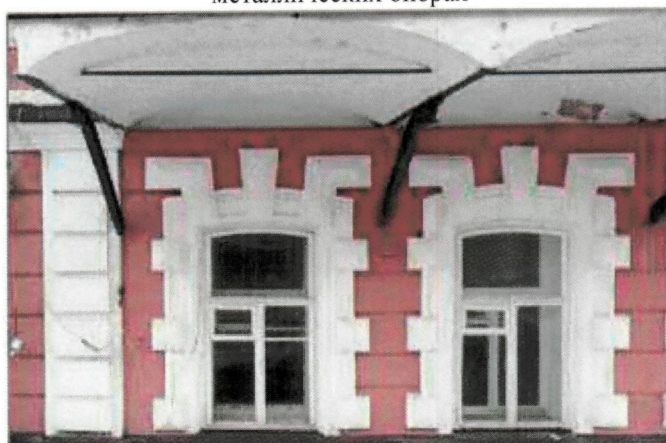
Сегментное (лучковое) перекрытие на металлических опорах
